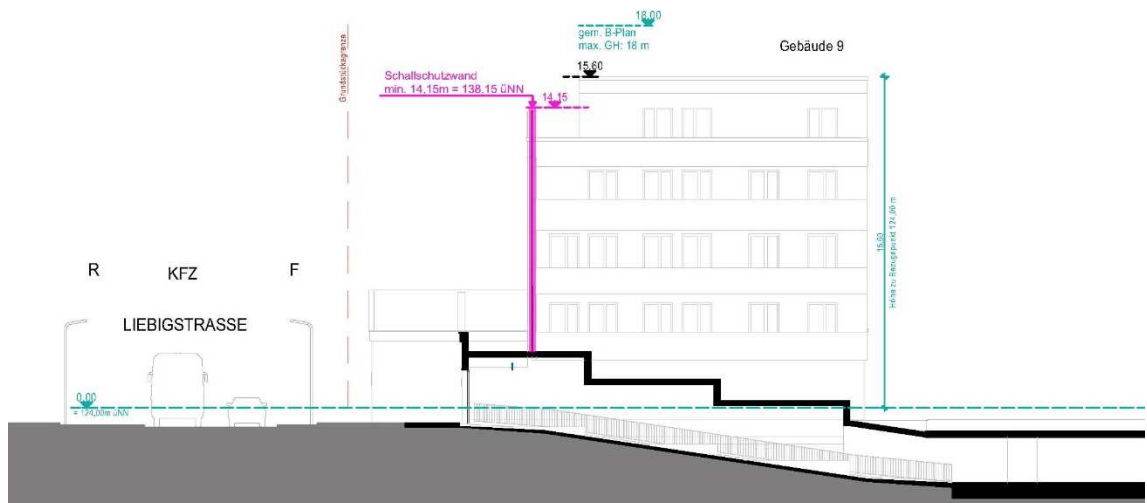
Schnitt West-Ost mit Darstellung Lärmschutzvorrichtung, Bereich zwischen Gebäuden 9 und 8 über TG-Zufahrt, Stand Oktober 2019
